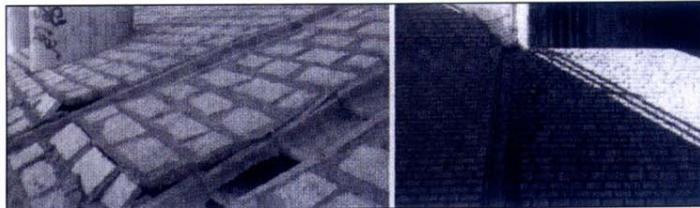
Estado del enchado de protección de un terraplén de viaducto.
